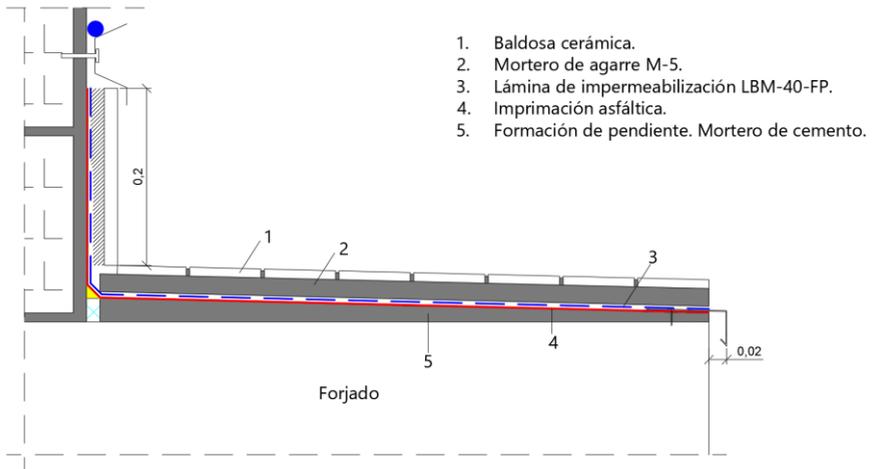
Detalle de cubierta de alero. (Elaboración propia, 2023).
